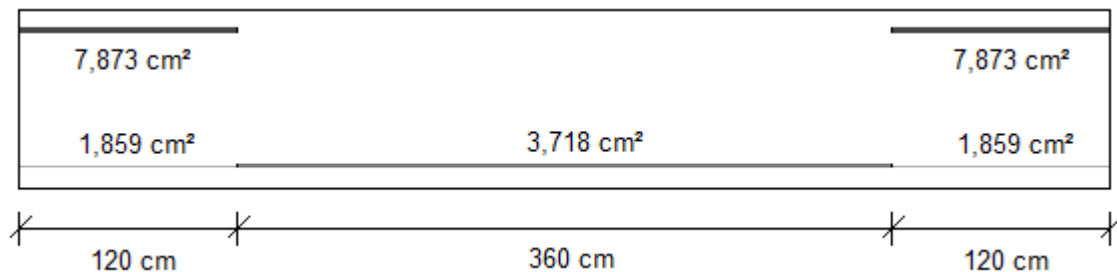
Seção longitudinal da viga do exemplo 4.
